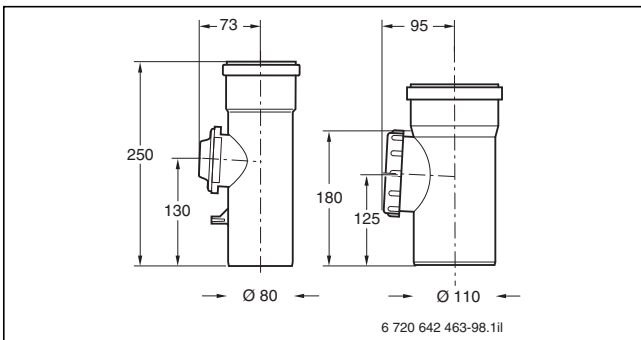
Rohr mit Prüföffnung (Maße in mm)
